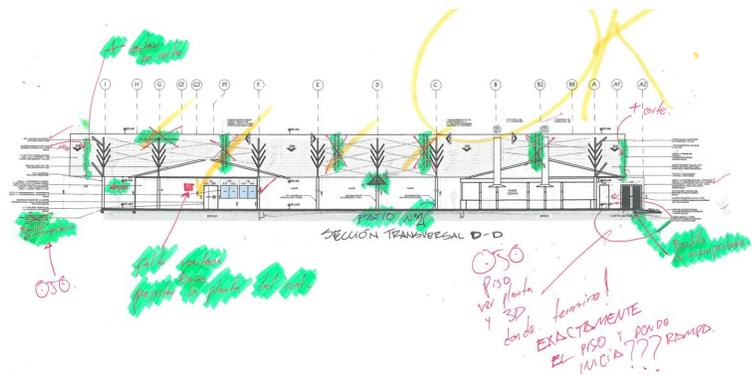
Plano: Secciones Proyecto Tiangué.
